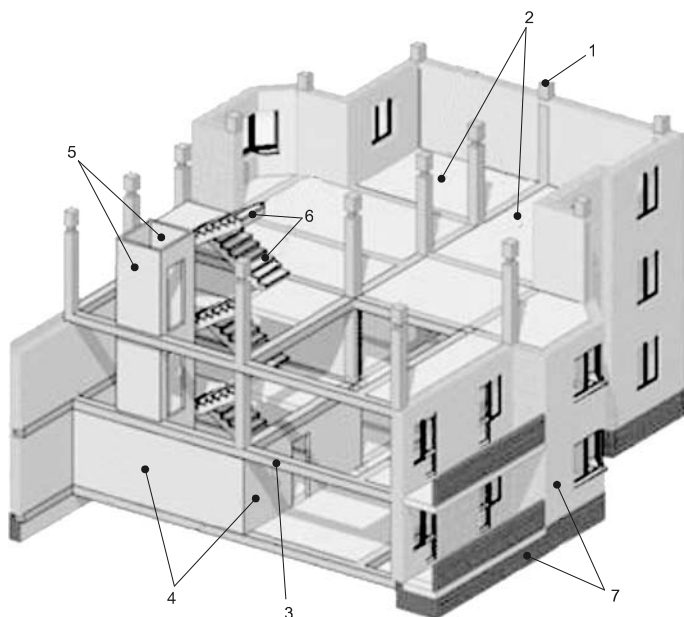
Каркас: 1 — колонна сборная (железобетон); 2 — железобетонные пустотные плиты перекрытия; 3 — монолитные связевые и несущие ригели; 4 — диафрагмы жесткости; 5 — панели шахт лифтов, предназначенных для грузопассажирских перевозок; 6 — лестничные марши; 7 — облицовка стен камнем, полученным на вибропрессовом оборудовании
